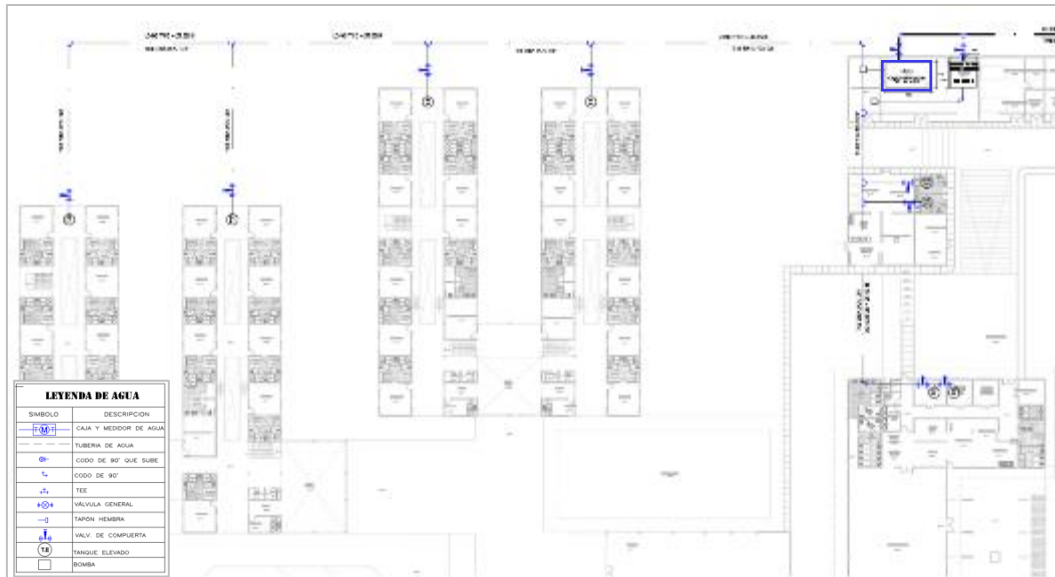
Cálculo de Cisterna y tanque elevado -Plano de Agua – sector 3. Fuente: elaboración Propia
